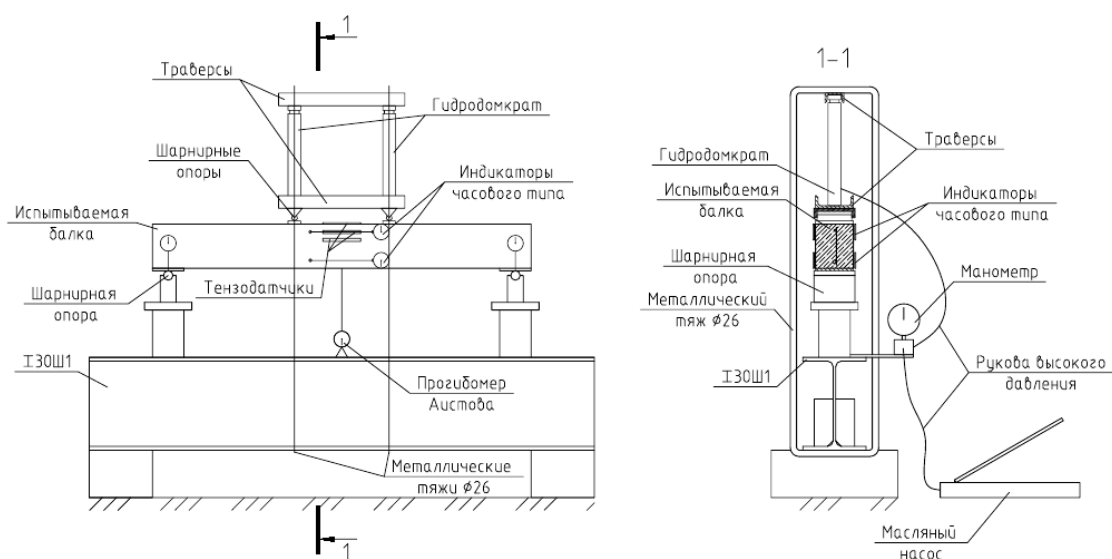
Схема универсальной испытательной установки с установленной железобетонной балкой и измерительными приборами
